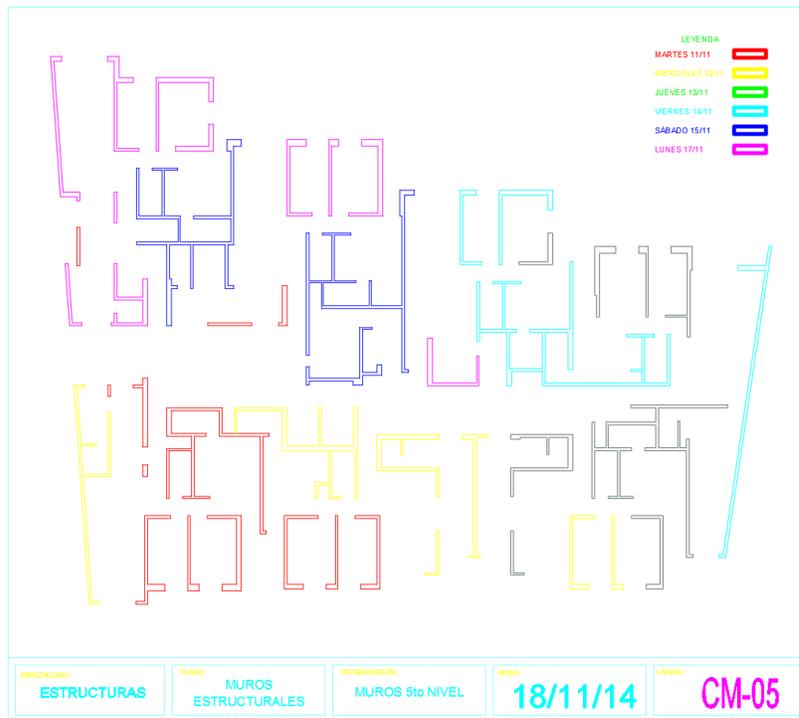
Sectorización de Muros Nivel 5. Fuente: Elaboración Propia
